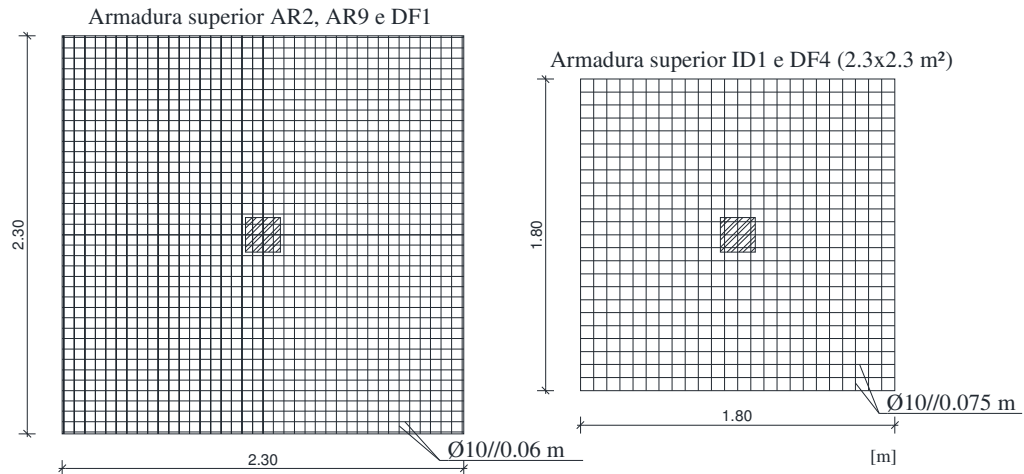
Armaduras longitudinais superiores dos modelos.
